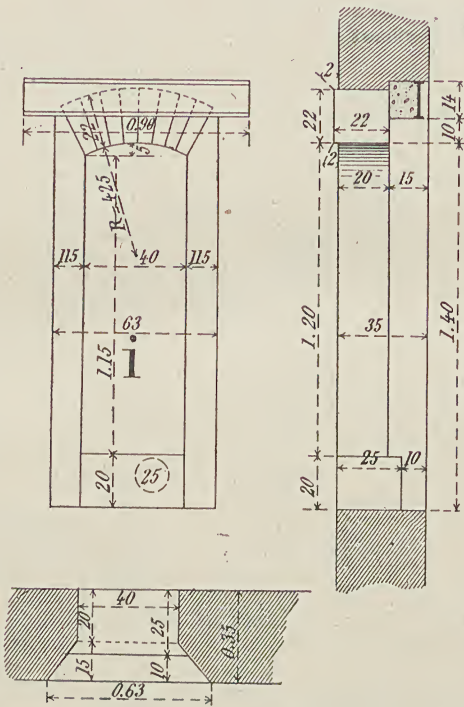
à 608. — Baie i, élévation intérieure, coupe et plan.
